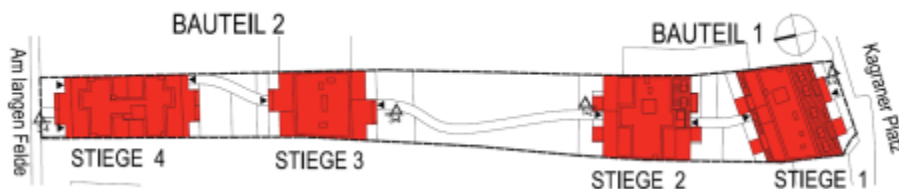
Lageplan der Gebäude – BVH1¹²⁰
